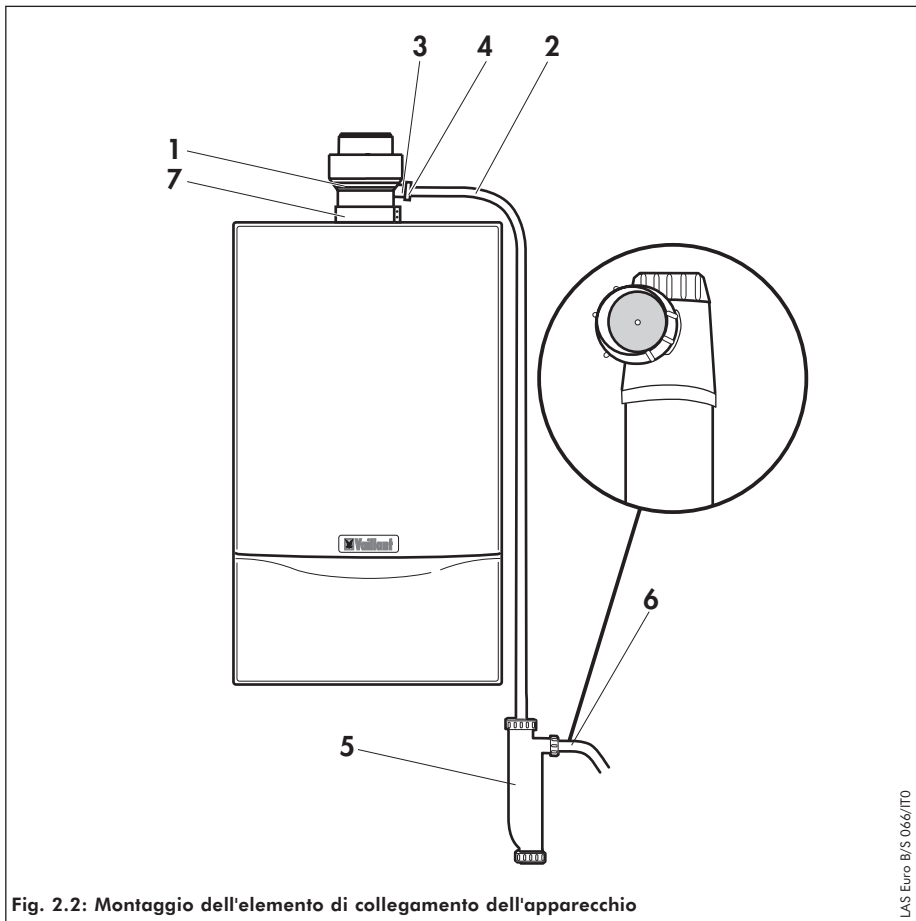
Montaggio dell'elemento di collegamento dell'apparecchio
